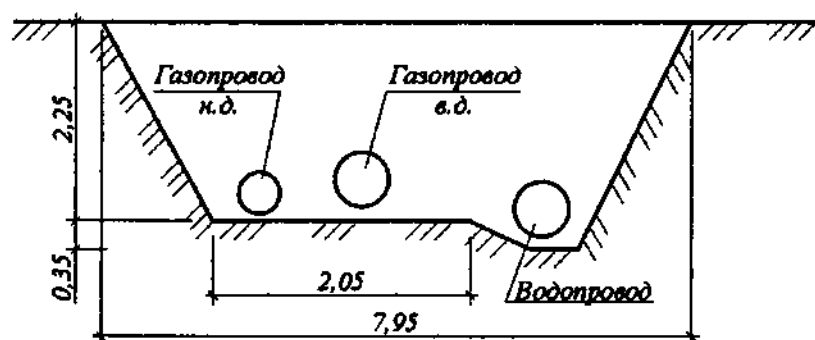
Совмещенный способ прокладки подземных сетей в одной траншее:
